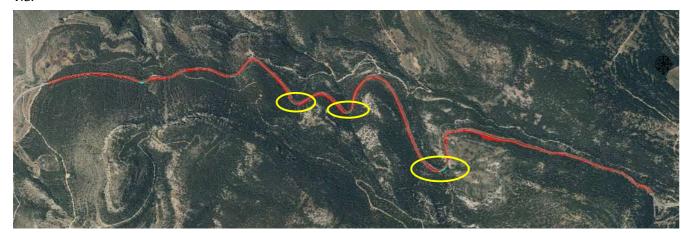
Trazado en planta actual del tramo objeto de estudio.
